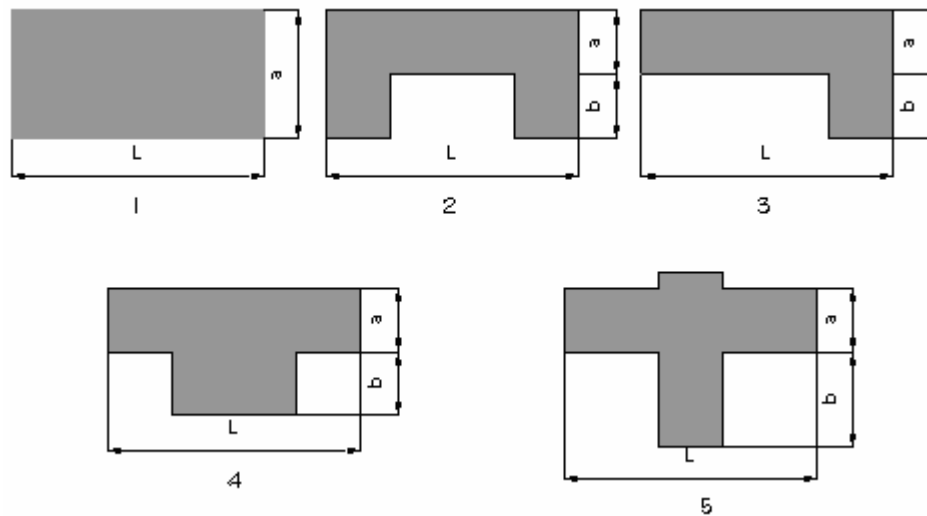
Configuración en planta de la estructura. Fuente: NRS - 98
